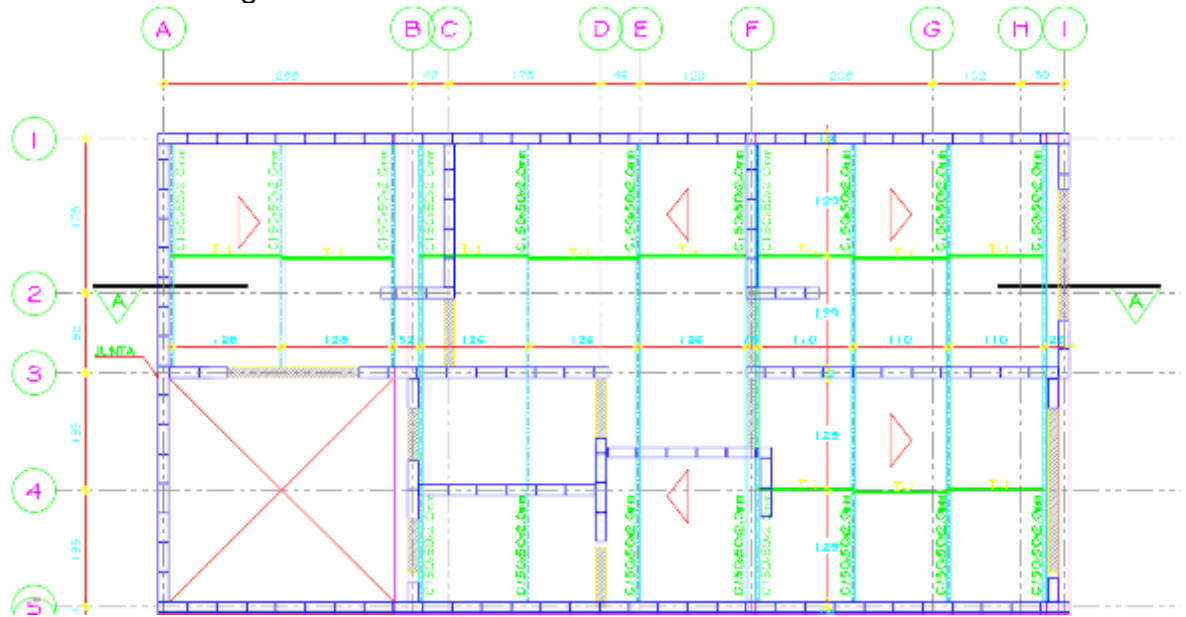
Detalle vigas dintel casa medianera actualizadas
